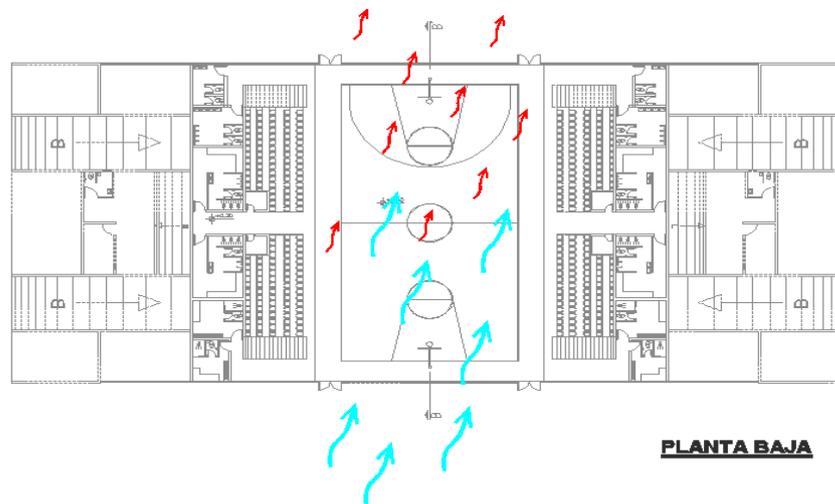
ANÁLISIS VENTILACIÓN PLANTA.
